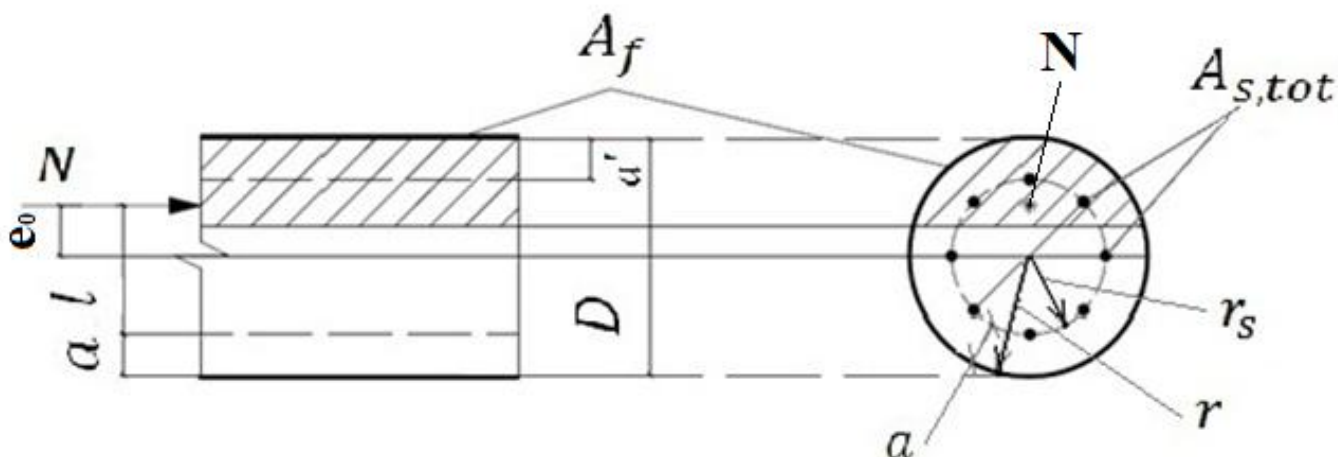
Расчетная схема для расчета композитно усиленных элементов круглого сечения
